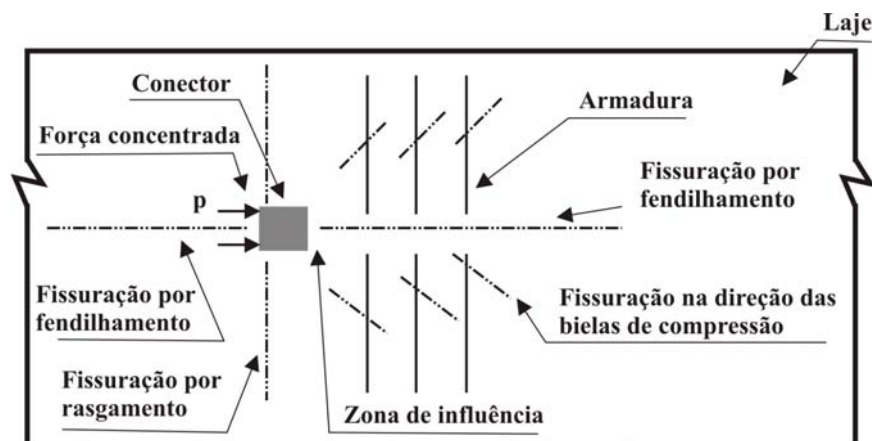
Tipos de fissuração na laje devida à força concentrada (OEHLERS, 1989).
